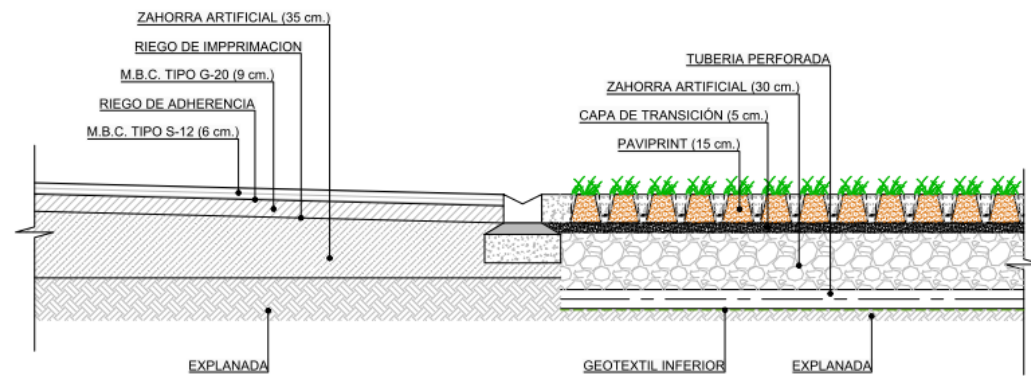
Detalle de pavimento asfáltico y pavimento de césped.
